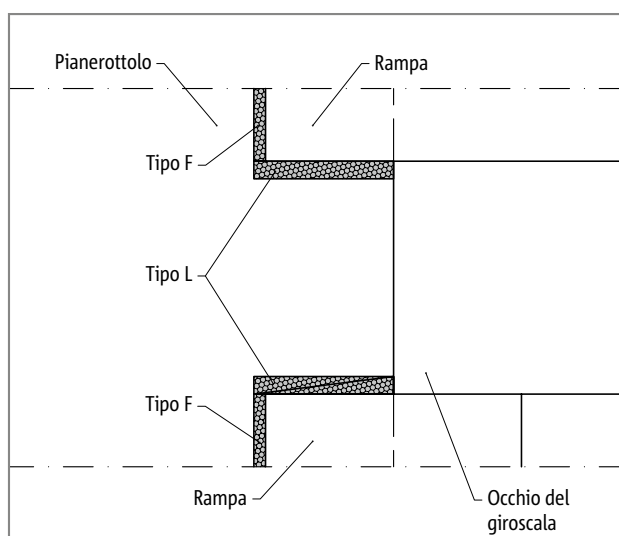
Schöck Tronsole® tipo F, disposizione dell'elemento; dettaglio A
